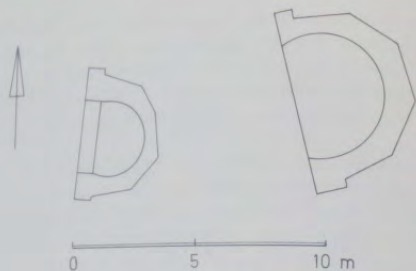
Kirchen 6 und 7, Grundriß. M 1:200
